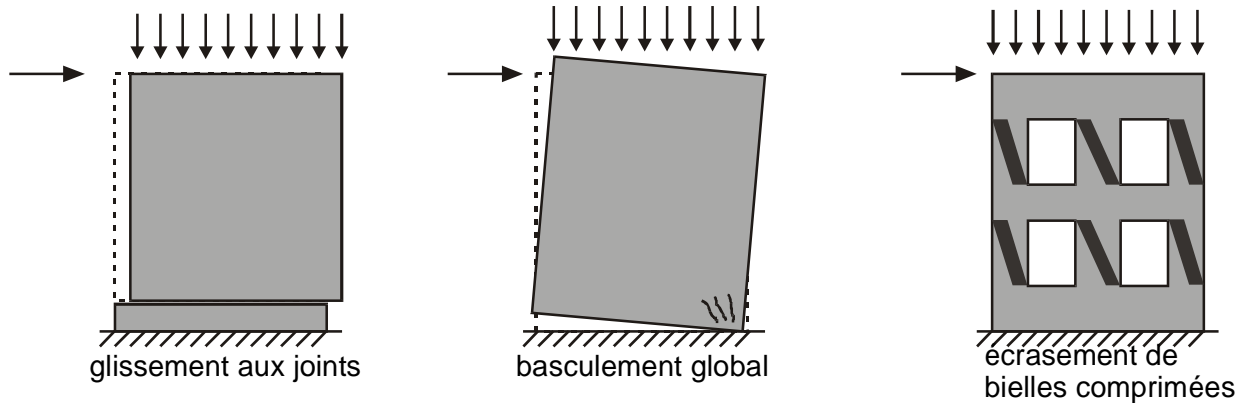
Mécanismes de rupture d'une maçonnerie dans son plan
